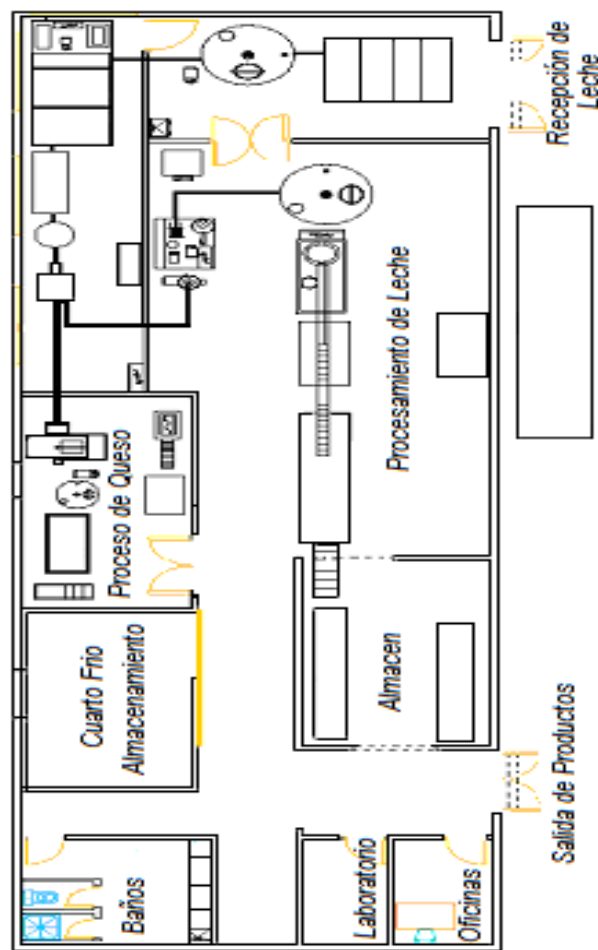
Bosquejo plano de instalaciones de planta de producción.
